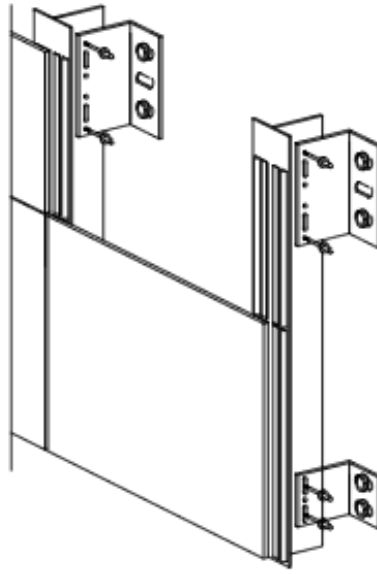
Taş kaplama klipsli sistem montaj detayı
